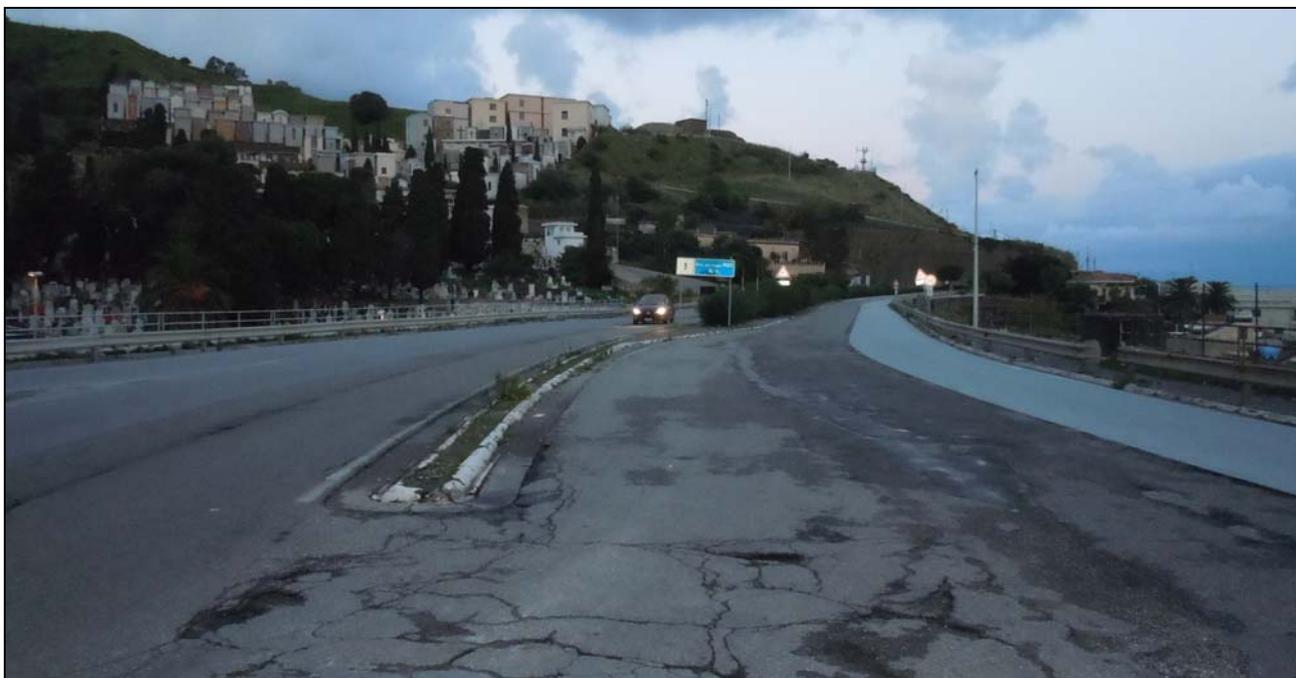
Via Fiumara Pace (Arco V-SE5) – Sezione trasversale; vista in direzione delle aree di cantiere
